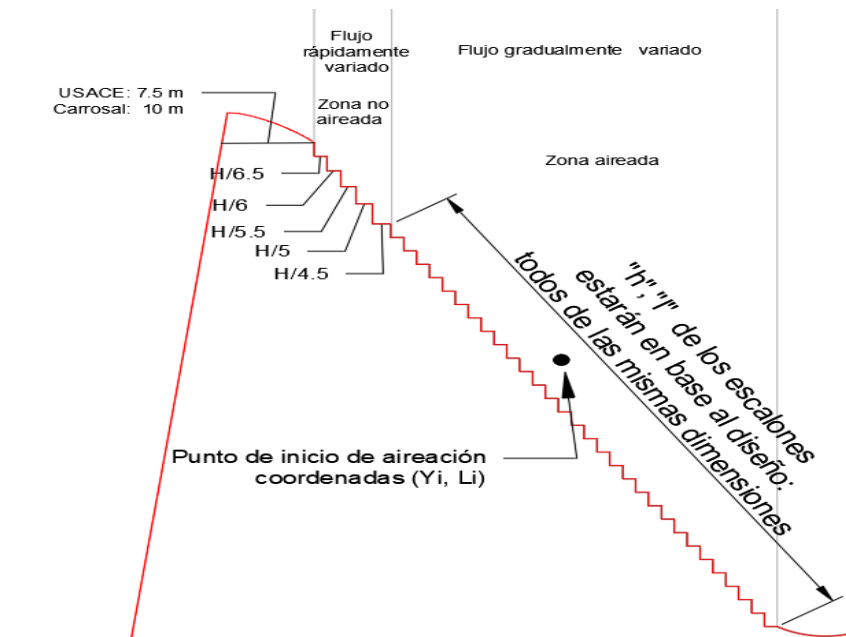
Construcción del perfil escalonado en el paramento aguas abajo
